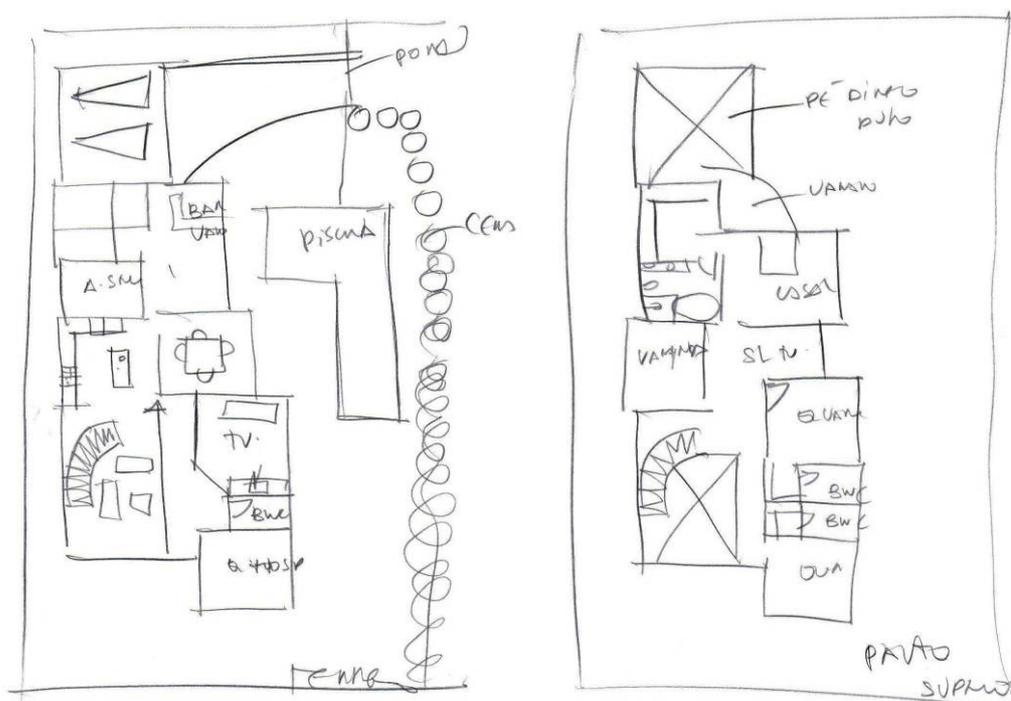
Croquis das plantas baixas dos pavimentos térreo e superior
